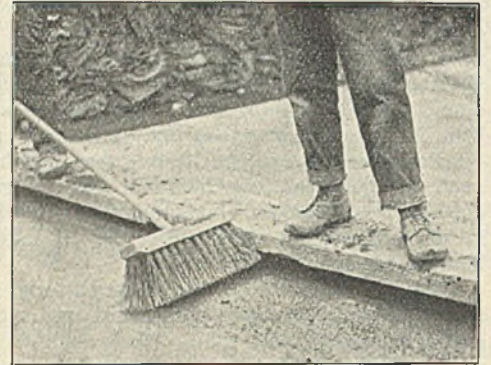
Anrauen der Oberfläche mit Besen (besonders in Steigungen).
